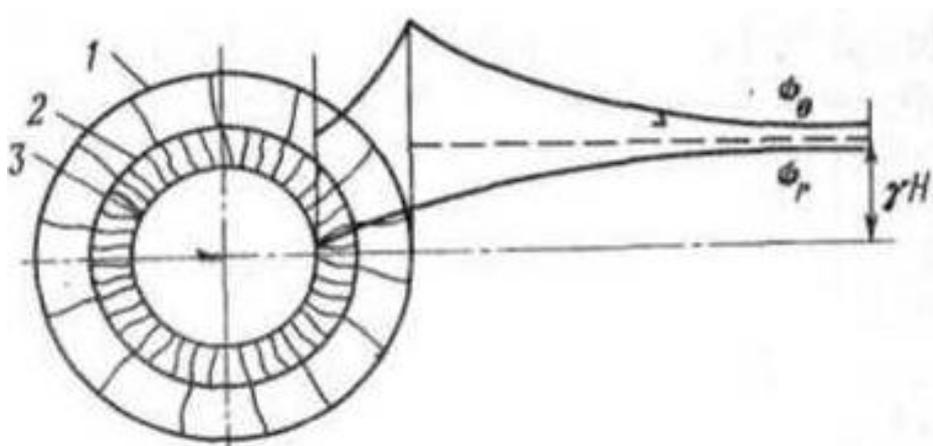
Схема проведения выработки в два этапа: 1 - зона неупругих деформаций; 2 - проектный контур выработки; 3 - передовая выработка
